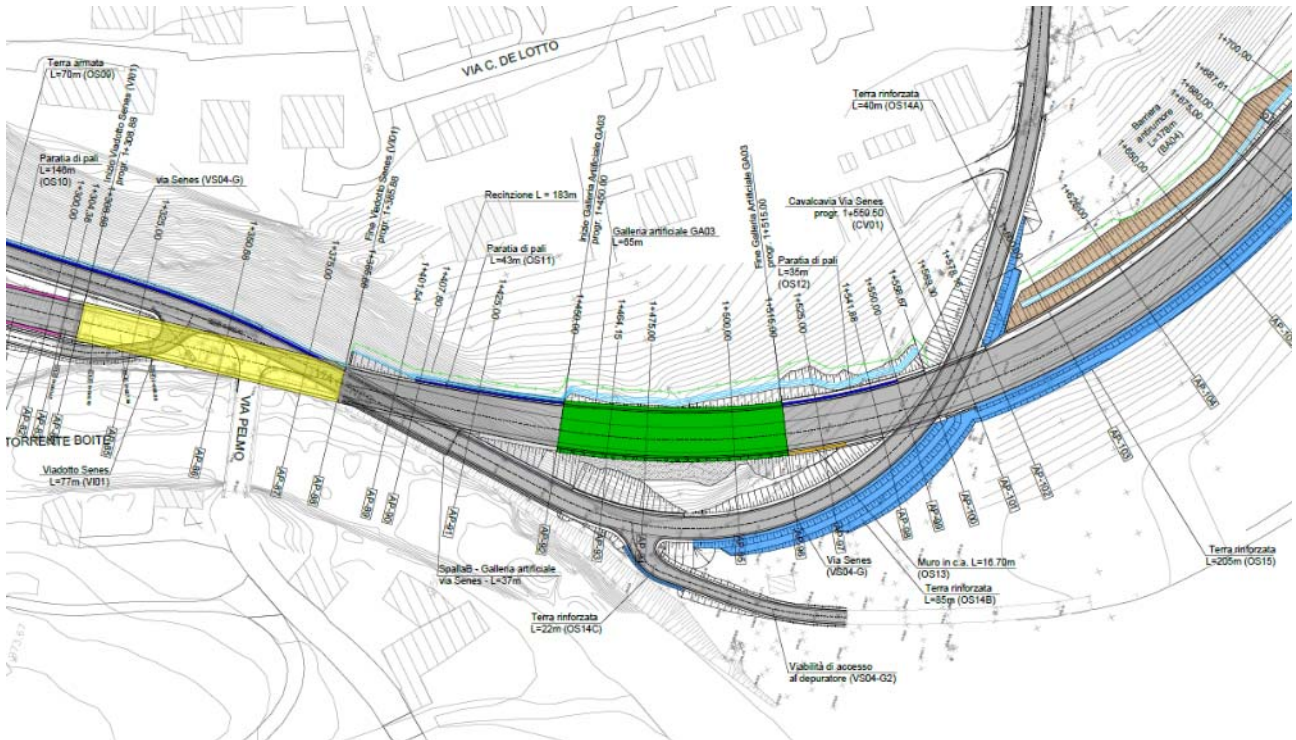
Stralcio planimetrico zona di attraversamento viabilità secondaria Via Senes e GA03
